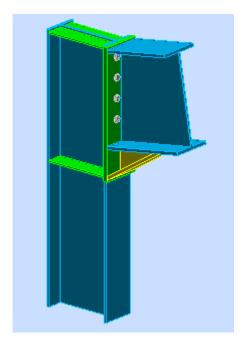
Vue en 3D d'assemblage poteau-traverse
